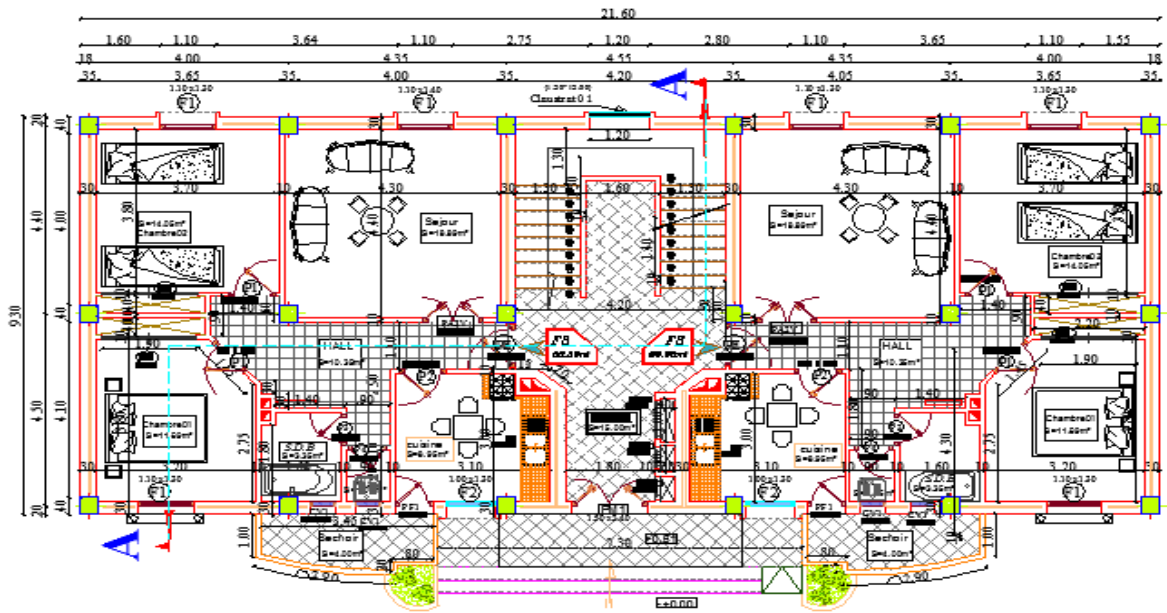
Plan d'architecte RDC et 1-2-3 éme étages
